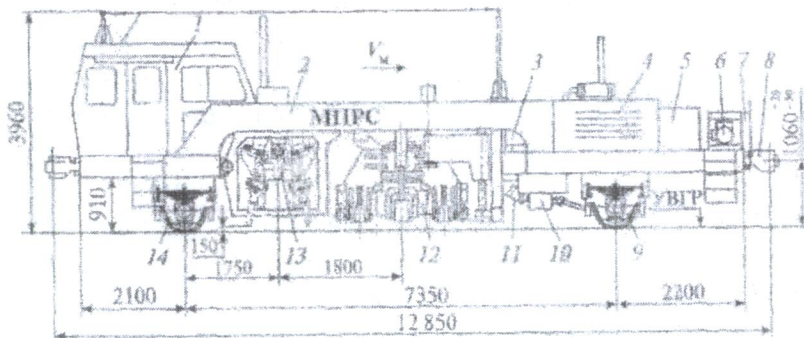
Машина для правки стыков рельсов в пути МПРС: 1 - кабина управления; 2 - рама; 3 - оборудование объемного гидропривода; 4 - силовой дизельный агрегат; 5 - топливный бак; 6 - бензо-электрический агрегат; 7 - силовой электрический щит; 8 - автосцепка; 9, 14 - приводная и не приводная колесные пары; 10 - трансмиссия; 11 - гидромотор рабочего передвижения; 12 - блок правки стыков рельсов (правый и левый); 13 - подбивочный блок
